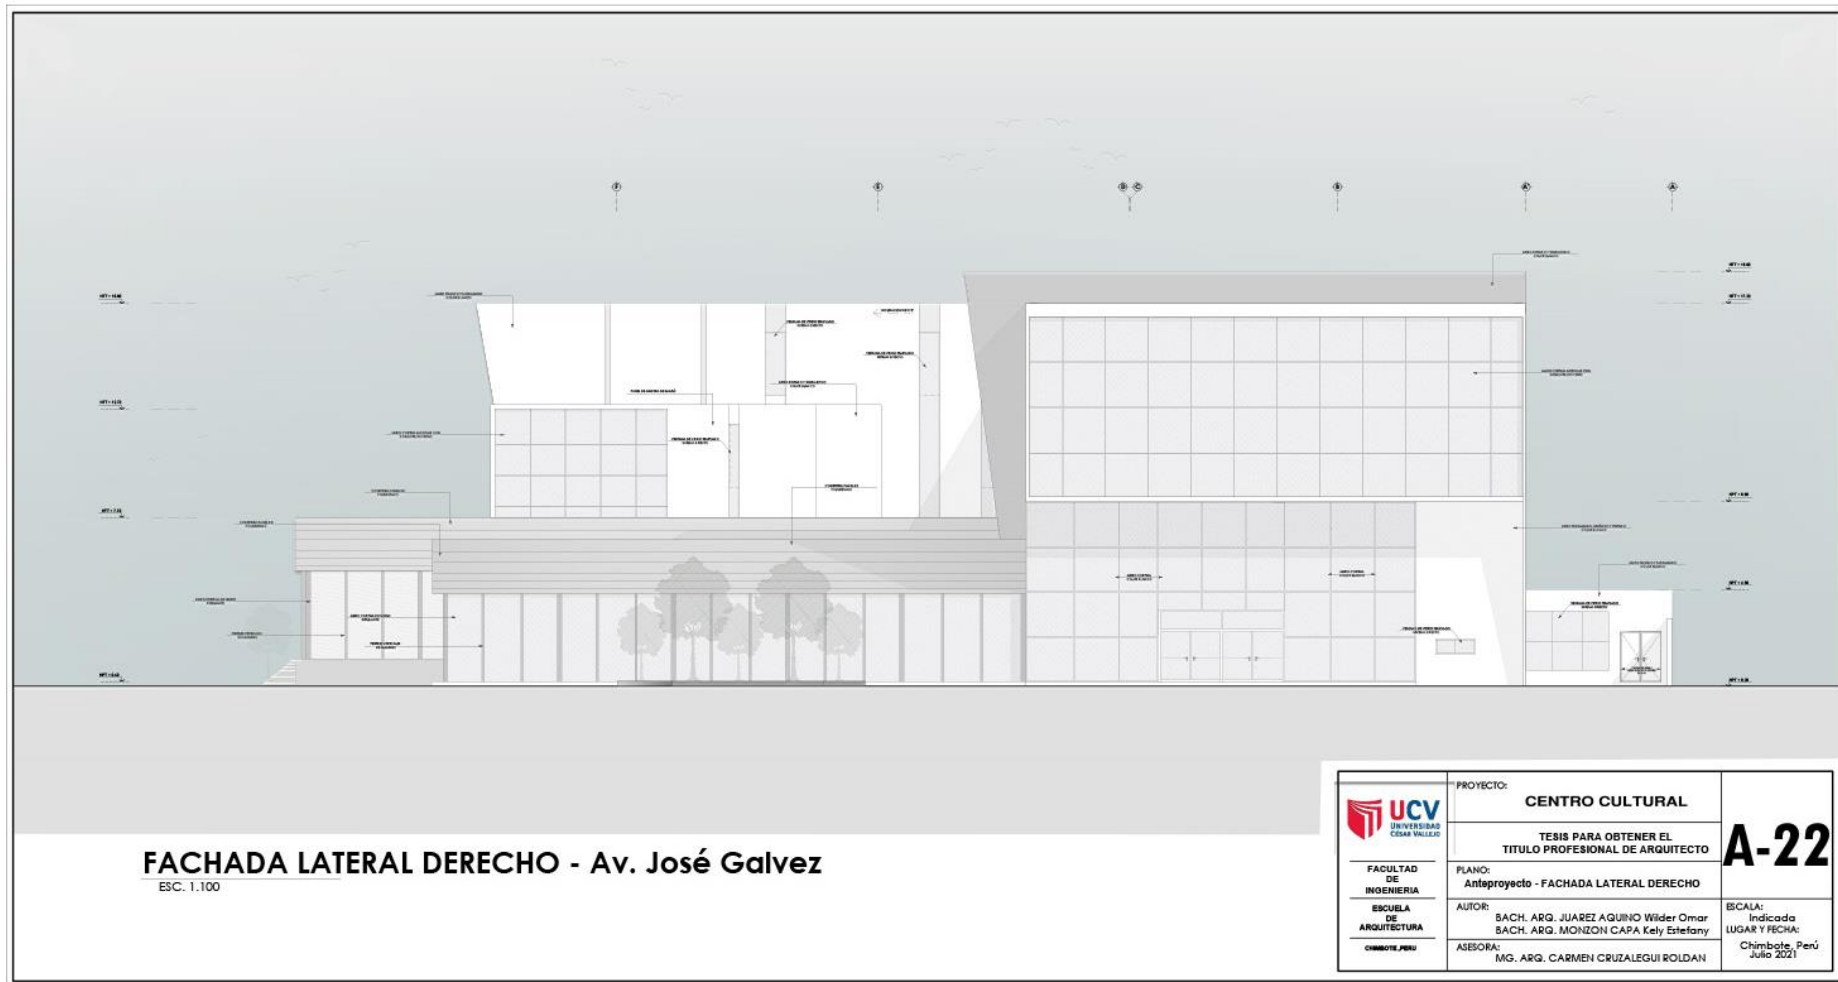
Fachada Lateral Derecho – Av. José Gálvez
